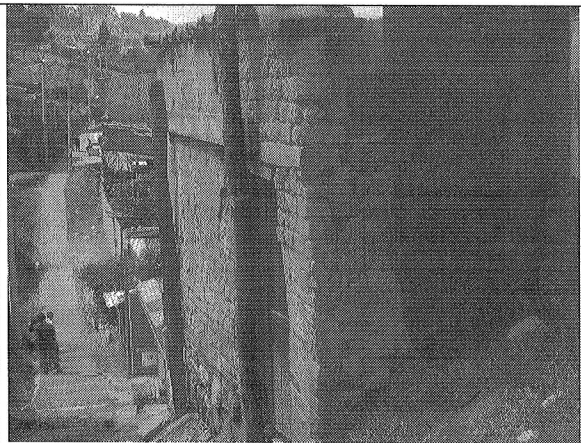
Pérdida de verticalidad y apuntalamiento provisional del muro del costado oriental.
